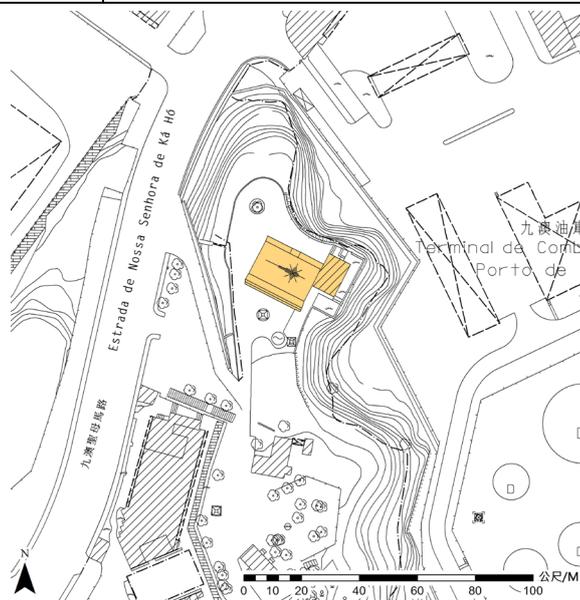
Planta de implantação do imóvel em vias de classificação
